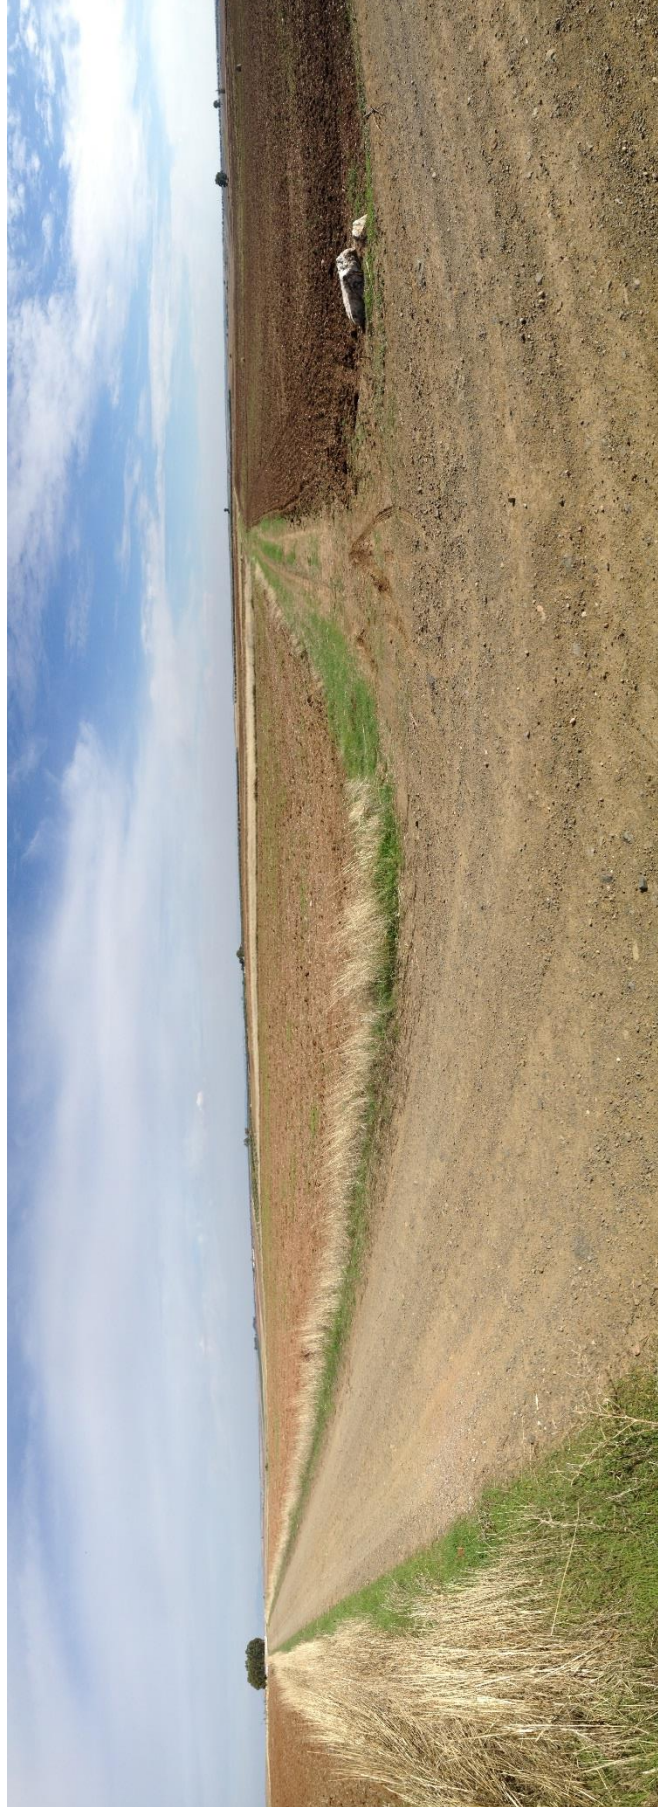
Terrenos de ubicación de la central situados al norte
